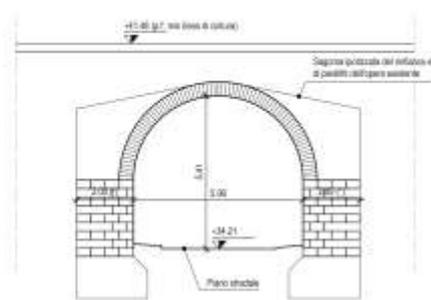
Sottovia ferroviario via Colombo, stato di fatto: prospetto sud e sezione trasversale
